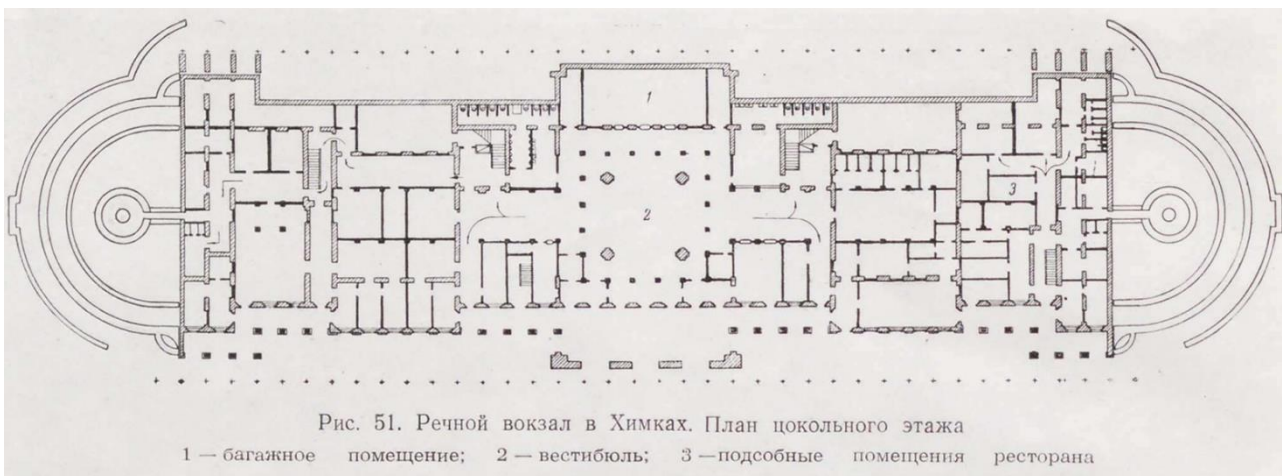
Речной вокзал в Химках. План цокольного этажа
